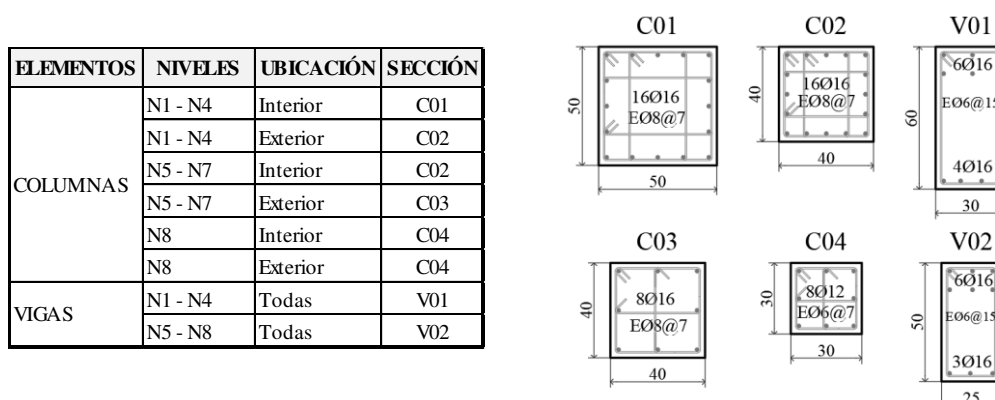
Secciones de hormigón armado en extremos de vigas y columnas.
